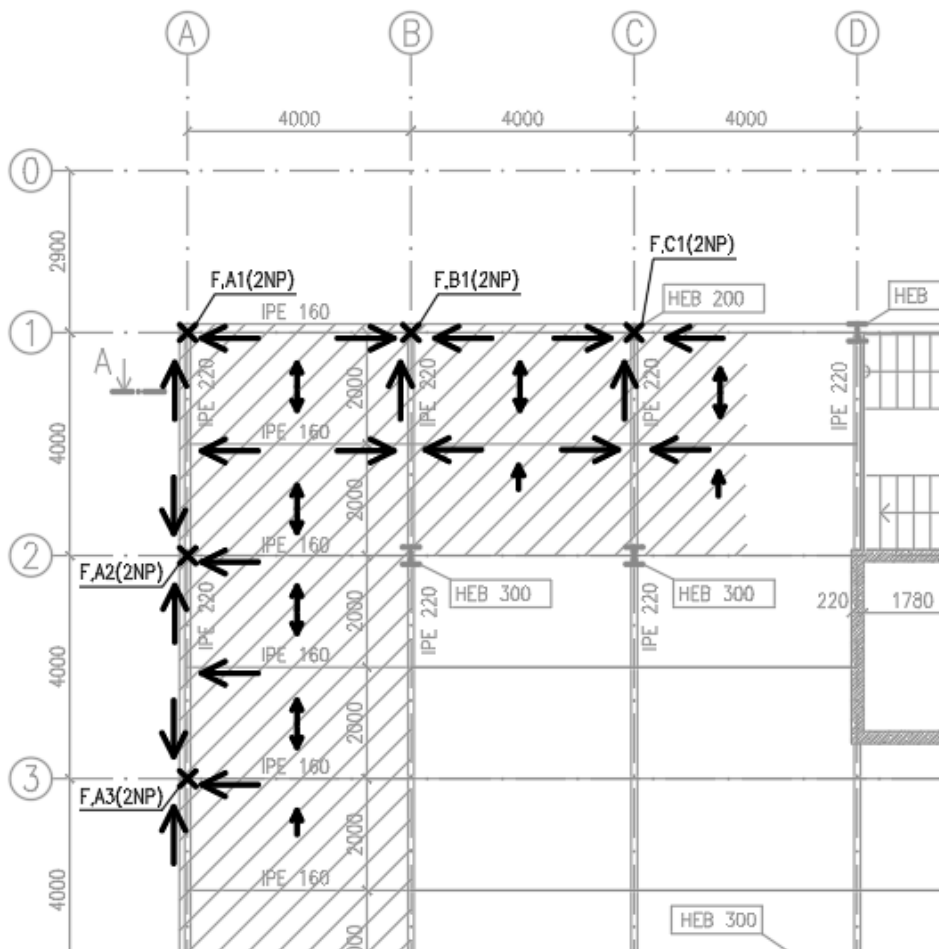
Konstrukční schéma řezu A-A; Nasčítávání reakcí po podlažích a místo napojení na příhradovou konstrukci (příhradová konstrukce není zobrazena)
